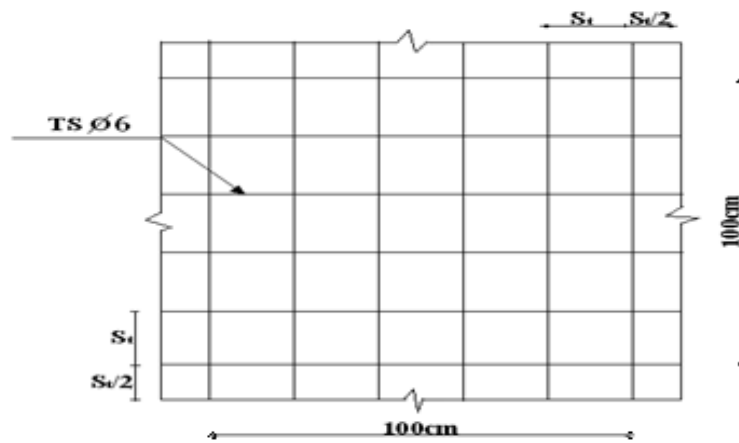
Disposition constructive des armatures de la table de compression- plancher
